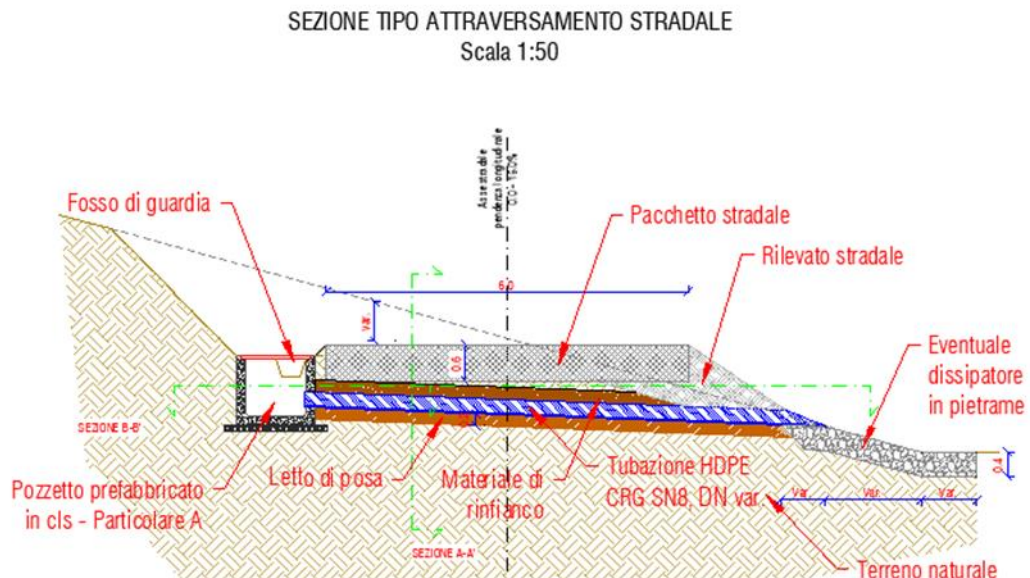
Estratto da tavola di progetto - Attraversamento stradale di scarico.
